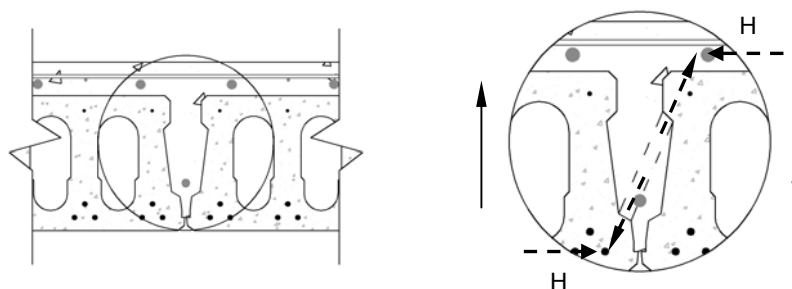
Mecanismo de transferência da força de corte entre duas pranchas de laje alveolar.
